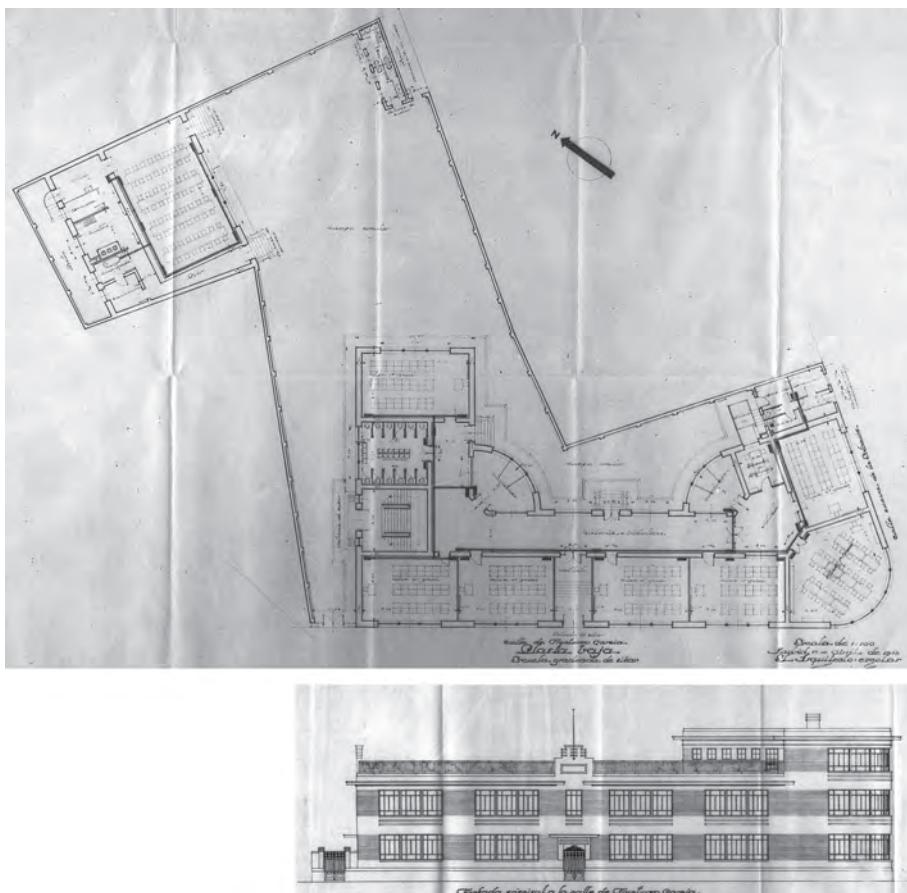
Grupo escolar San Fernando según proyecto original de Joaquín Muro (Valladolid, 1932): planta baja del conjunto y alzado suroeste (Fuente: Archivo General de la Administración).
